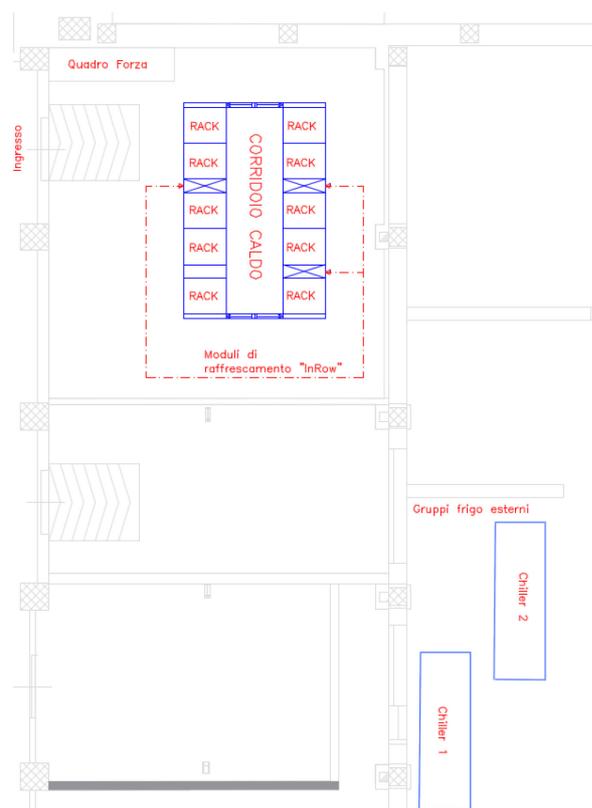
Locale NODO1 e layout dei rack e degli elementi di cooling
